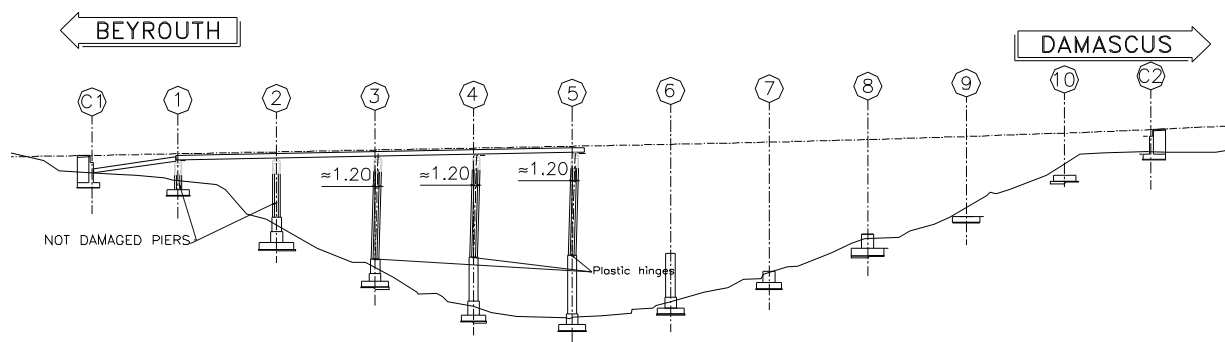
Profilo longitudinale della situazione dopo i bombardamenti
